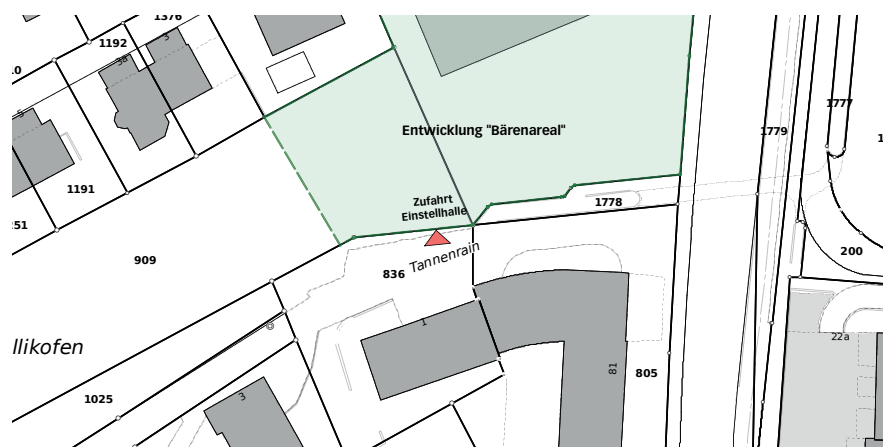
Situationsplan (amtliche Vermessung) mit dem Standort der Einstellhalle-Zufahrt zum Bärenareal (rot)
